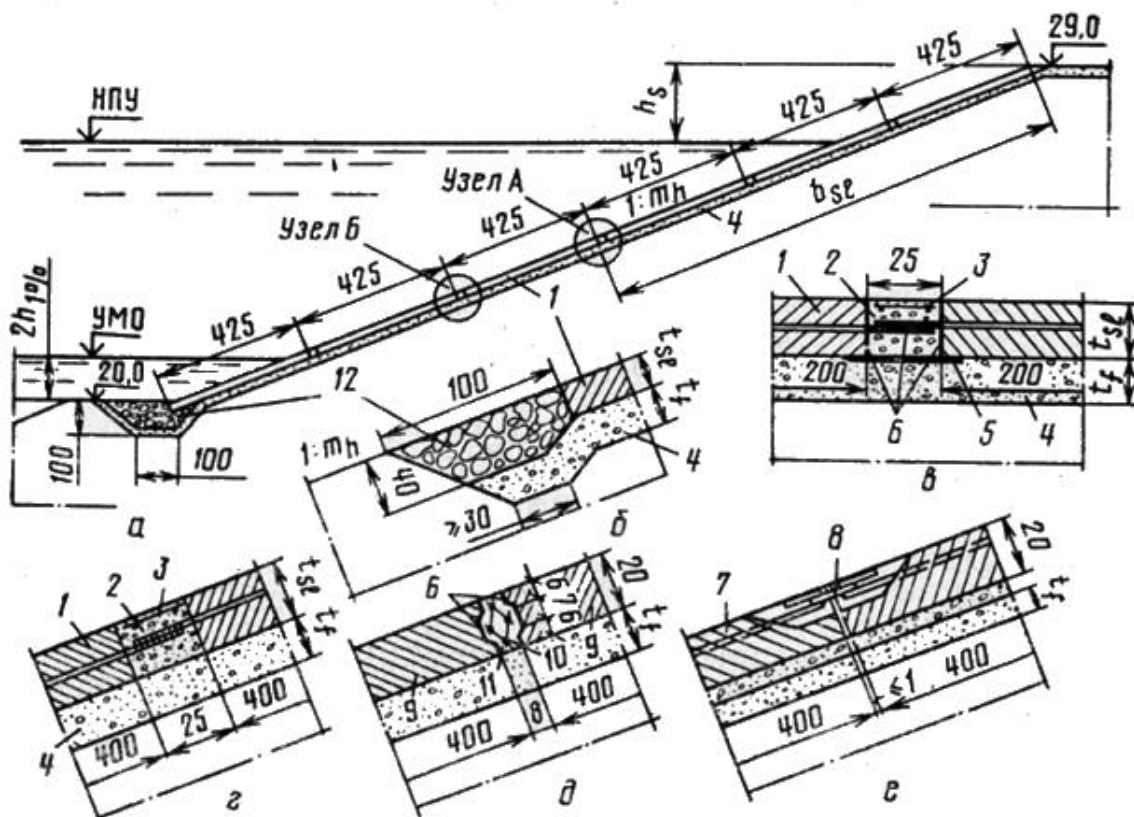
Конструкция крепления откоса плотины сборными железобетонными плитами [15]: А – разрез крепления; б – вариант упора крепления откоса без берм; в – поперечный температурно-осадочный шов
